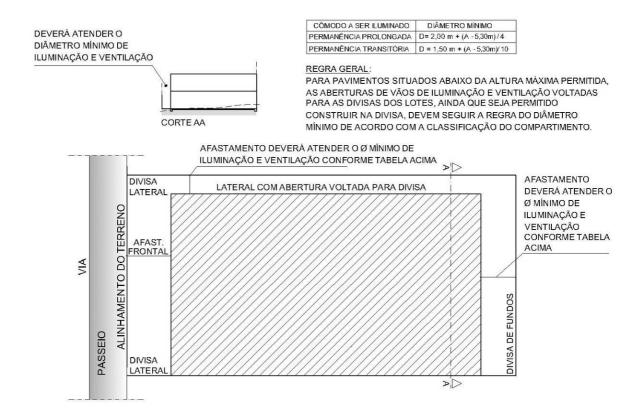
lluminação e ventilação de compartimentos em pavimentos voltados para as divisas dos lotes (regra geral)
